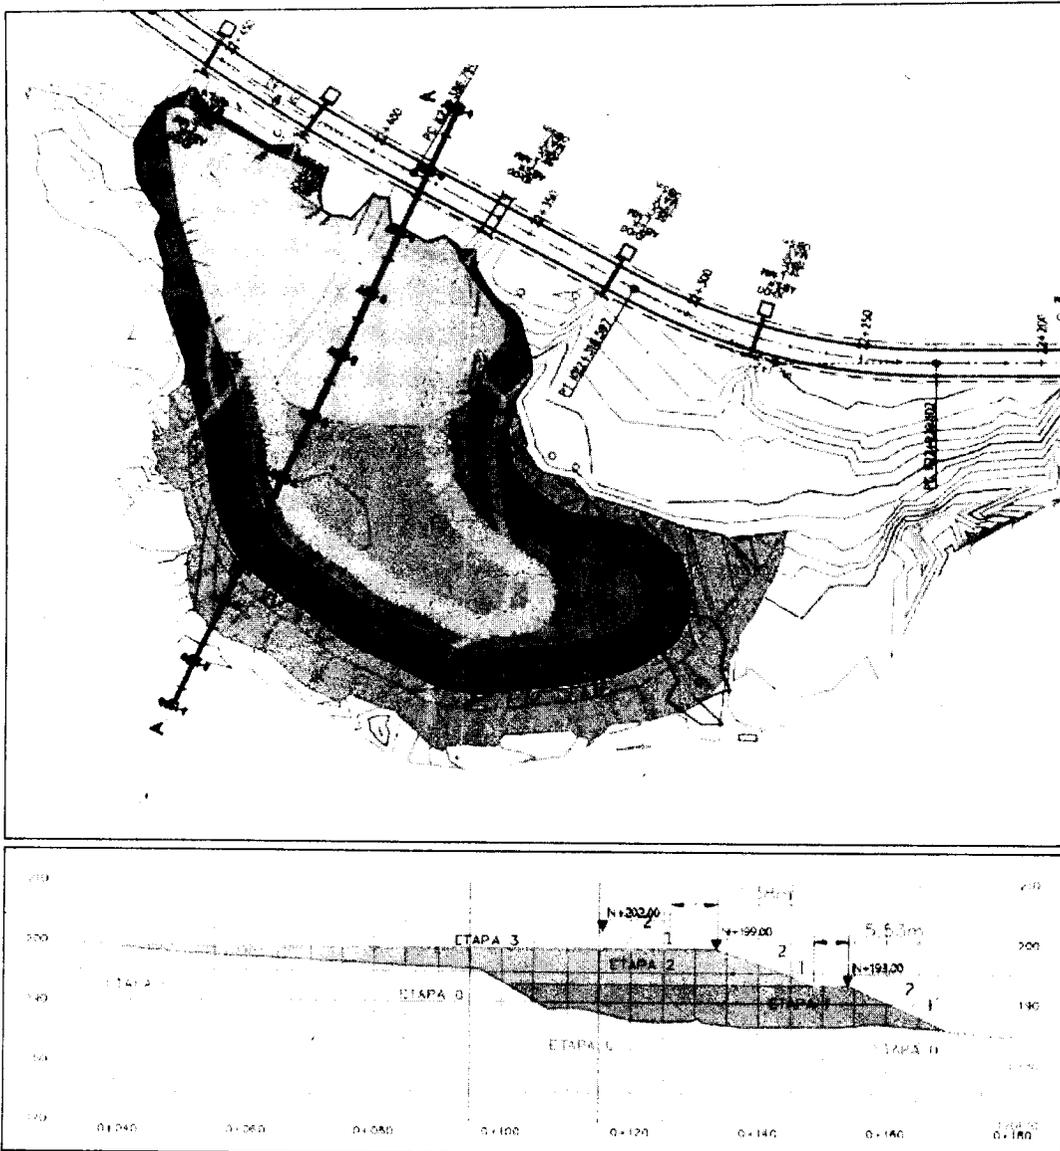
Vistas en planta y perfil del diseño geométrico de la ZODME propuesta
